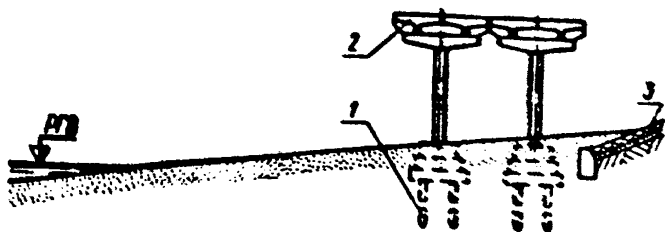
Железобетонная эстакада-набережная на песчаном пляже:
